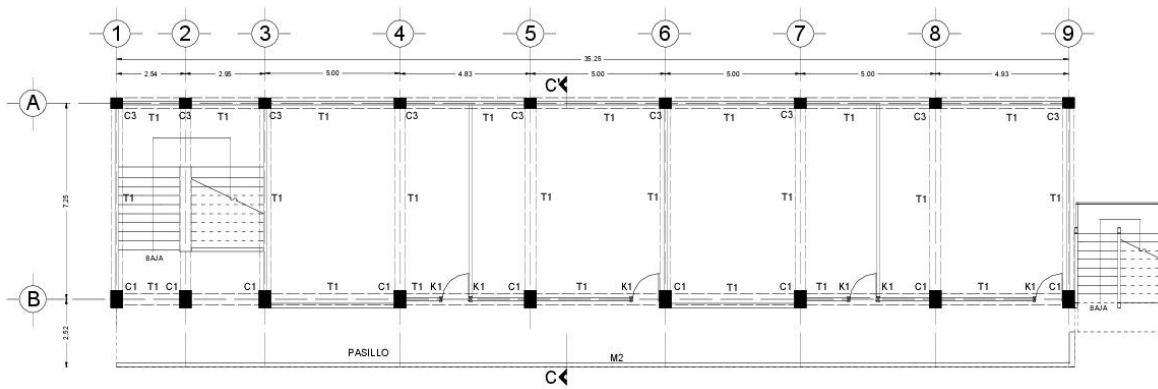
Croquis de dimensiones y elementos en planta del N4. (GACONSA, 2018)
